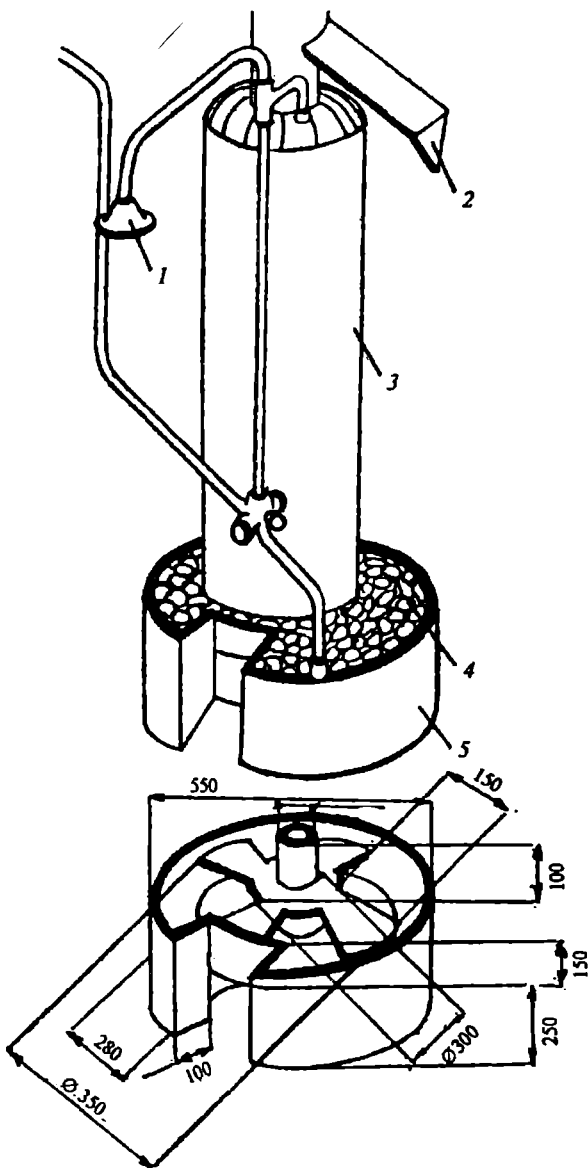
Нагреватель с каменкой и теплой душевой конструкции
